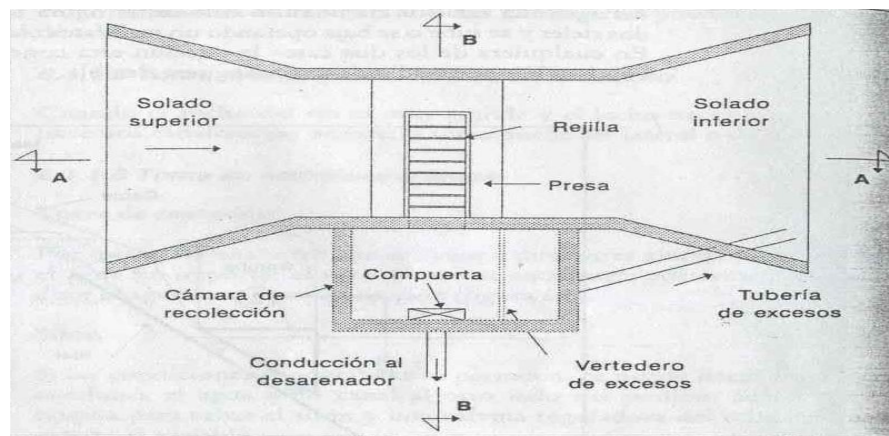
Bocatoma de fondo – Planta (López Cualla, 1995)
